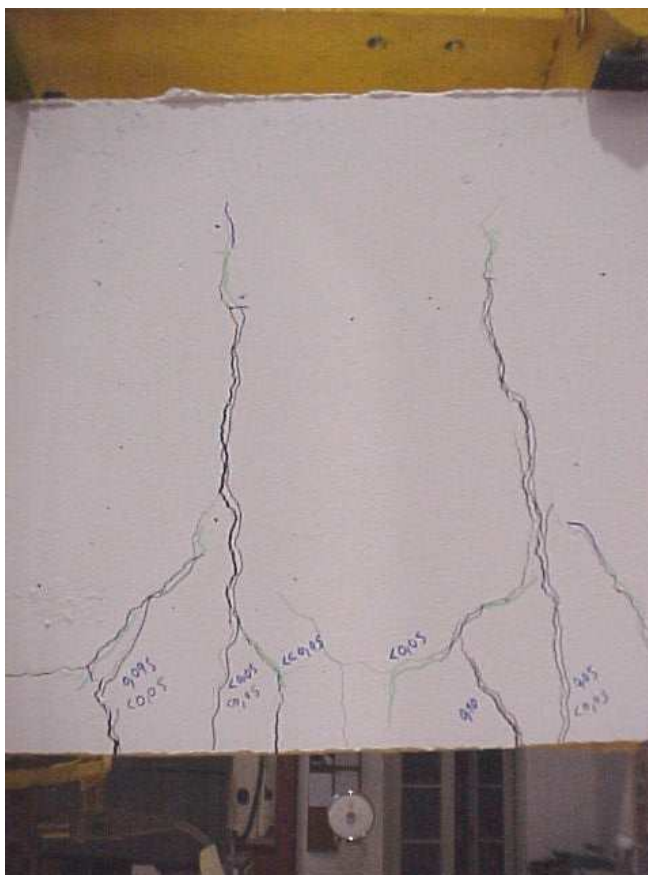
Pormenor da fendilhação da viga HSS3_C35_d14.
